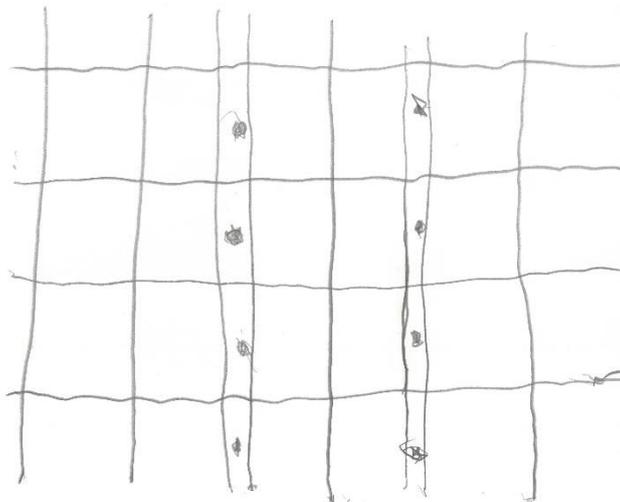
Esquiço de pormenor 1 do pavimento do espaço público do bairro da Parcela 6, em planta
